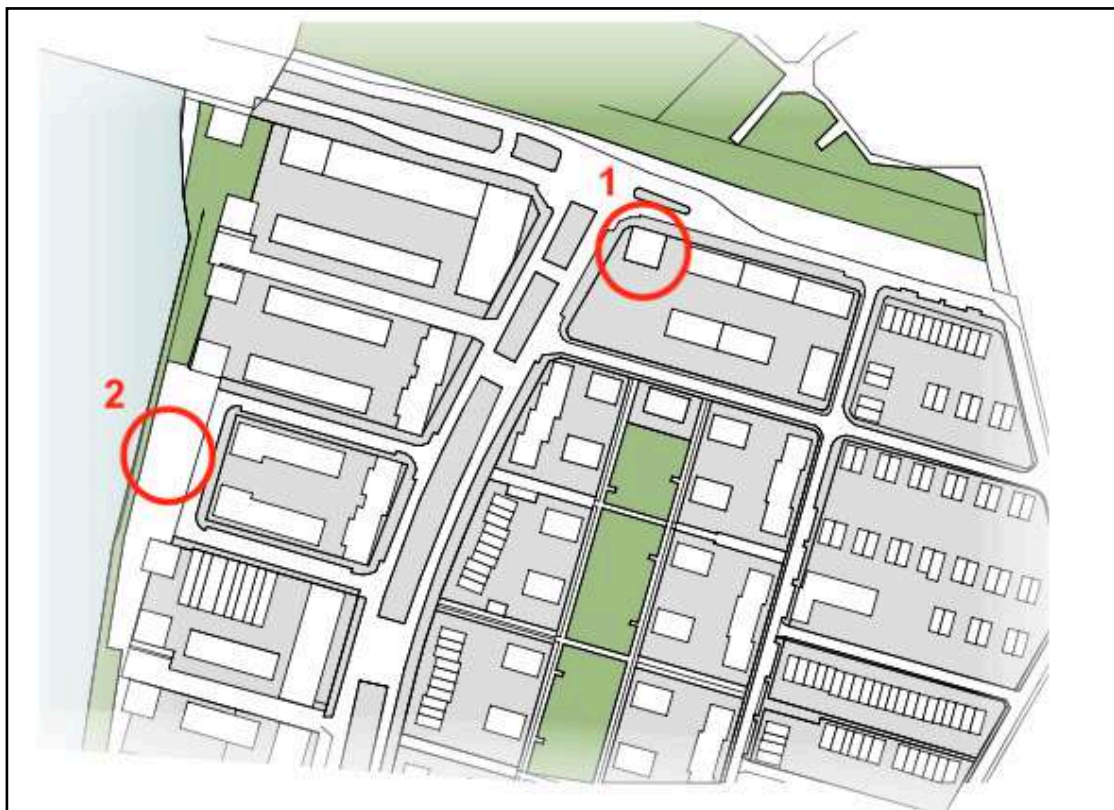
Grundriss des Optimierungsplans¹⁰²
